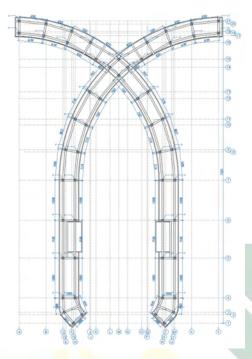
17 Denah Rangka Atap pada Parkiran Mobil
